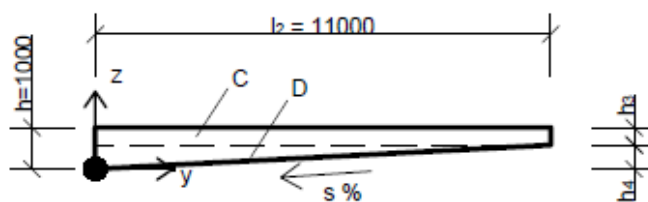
Půdorys výpočetního modelu ve 3D
